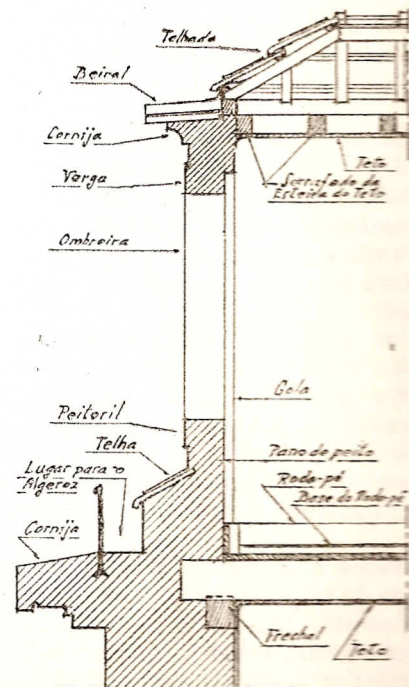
CORTE DA TRAPEIRA DE ALVENARIA
